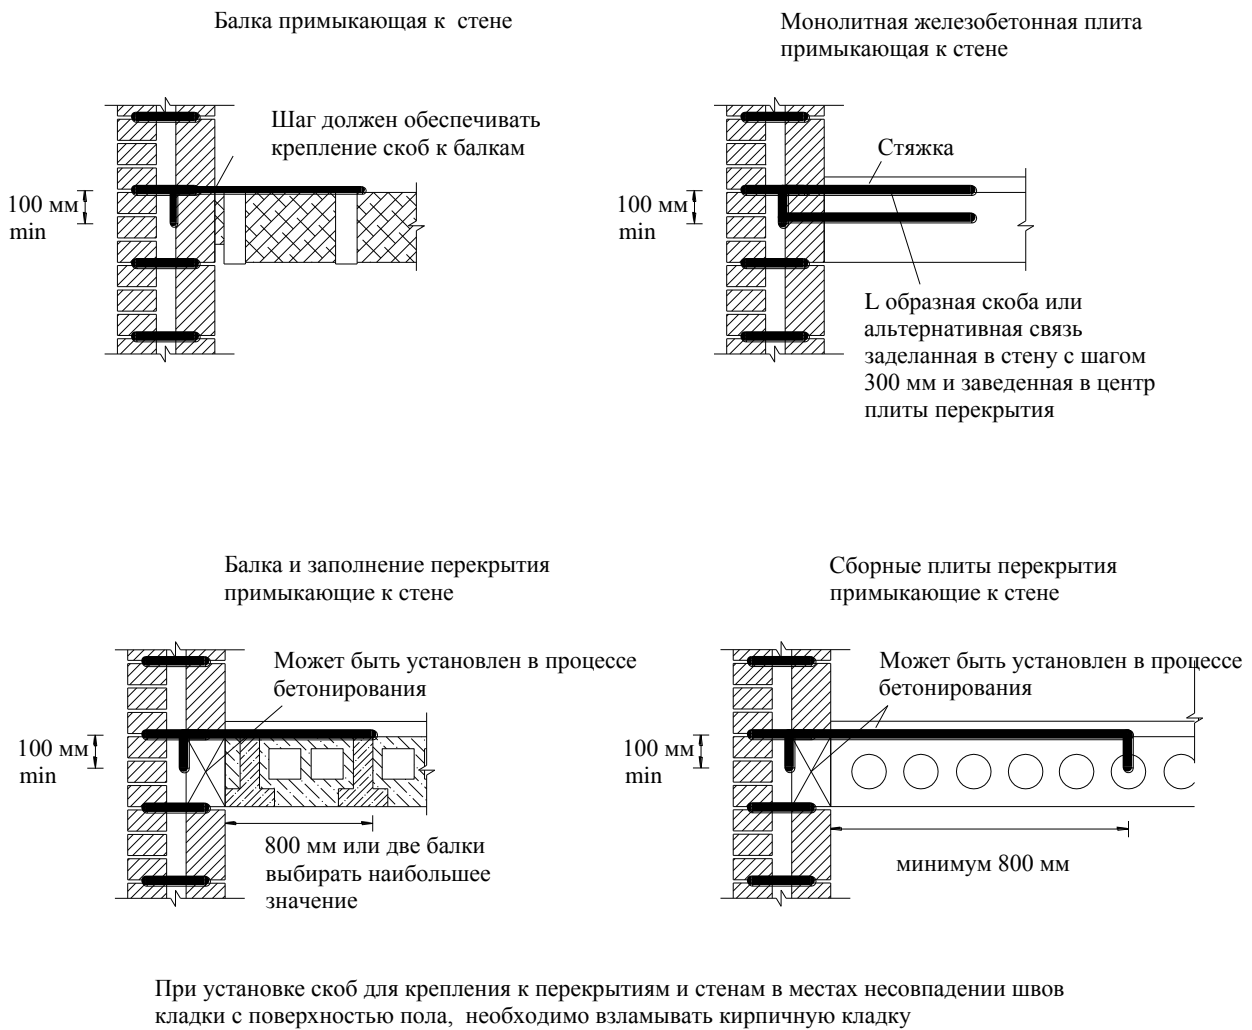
Опираение деревянных балок перекрытия на кирпичную стену с одной стороны
